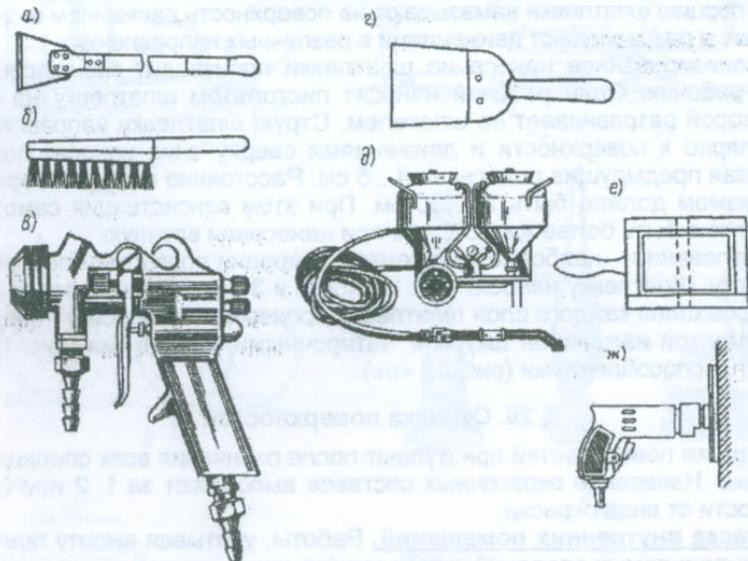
Механизмы и инструменты для подготовки поверхностей под окраску
